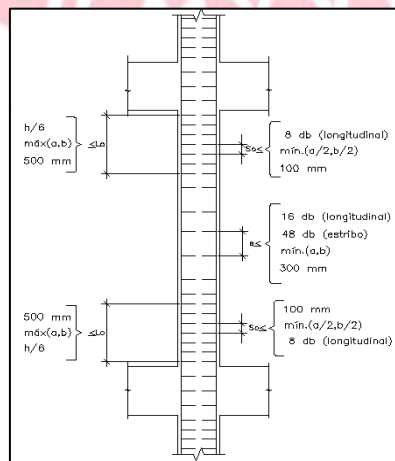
Requerimientos para el espaciamiento de columnas en edificios con sistema. de muros estructurales.
